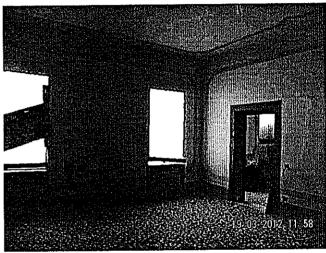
Stanza 1.8 Parete lato strada e porta sala
